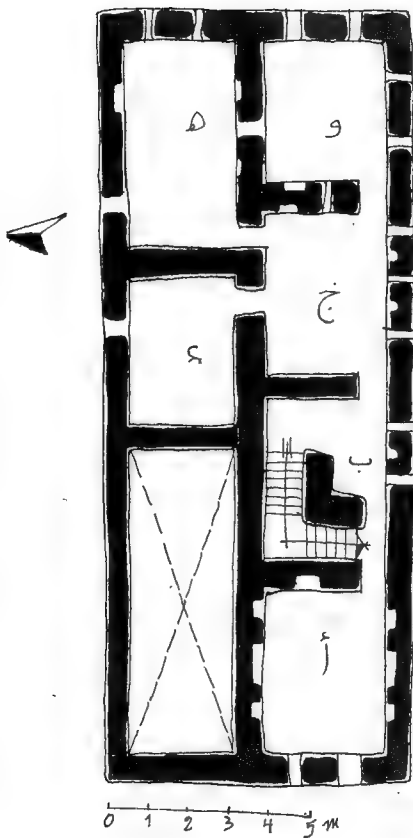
منزل الشريف أحمد الدور الأول مسقط الأفق "نقلا عن علي إيب محمد" مرجع سابق
